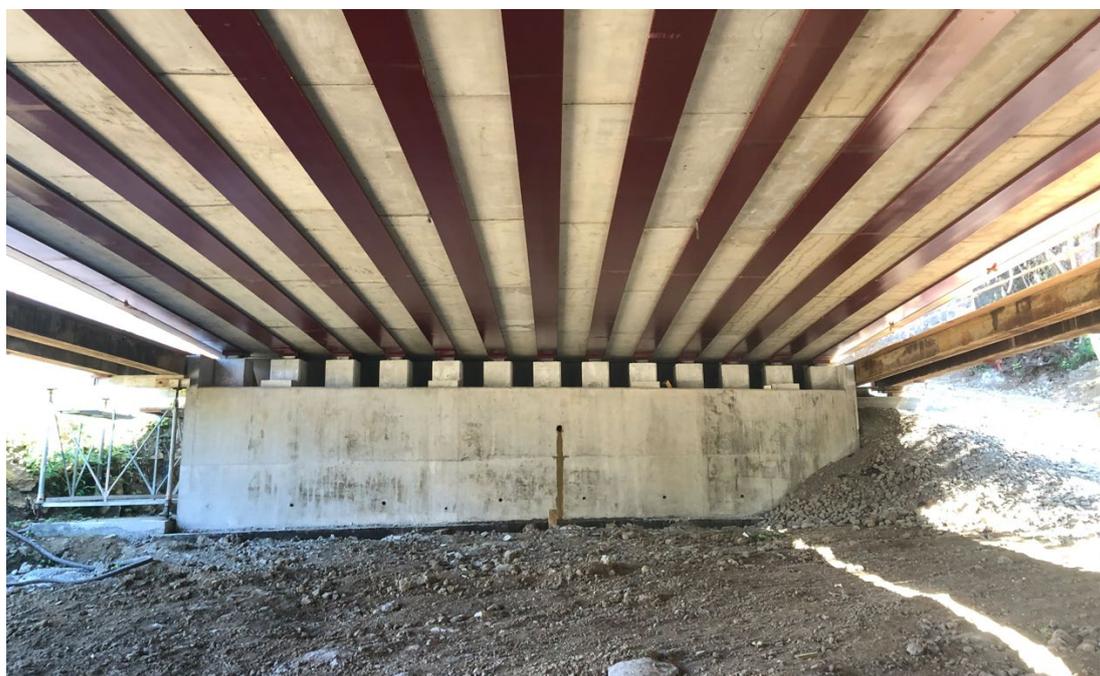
Exemple de pont à poutrelles enrobées (SUEZ Consulting, Ville de Saint-Pierre)
